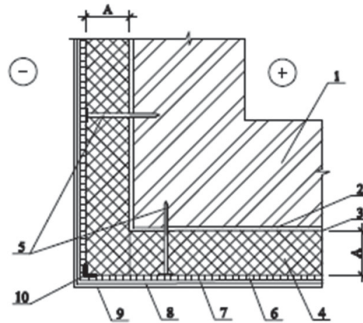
Конструктивна схема влаштування теплоізоляції по зовнішніх кутах будівлі
